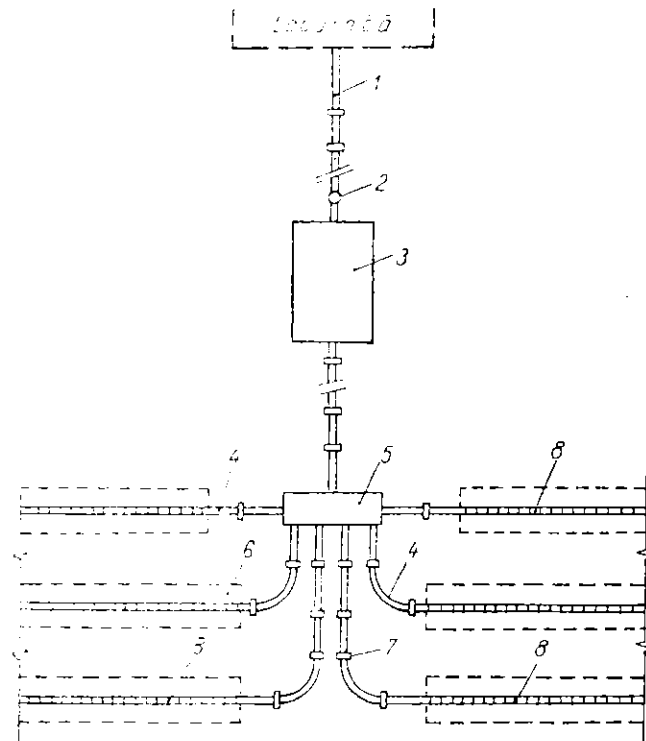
Schemă de dispoziție în plan a conductelor de dren pe teren denivelat (în trepte):
